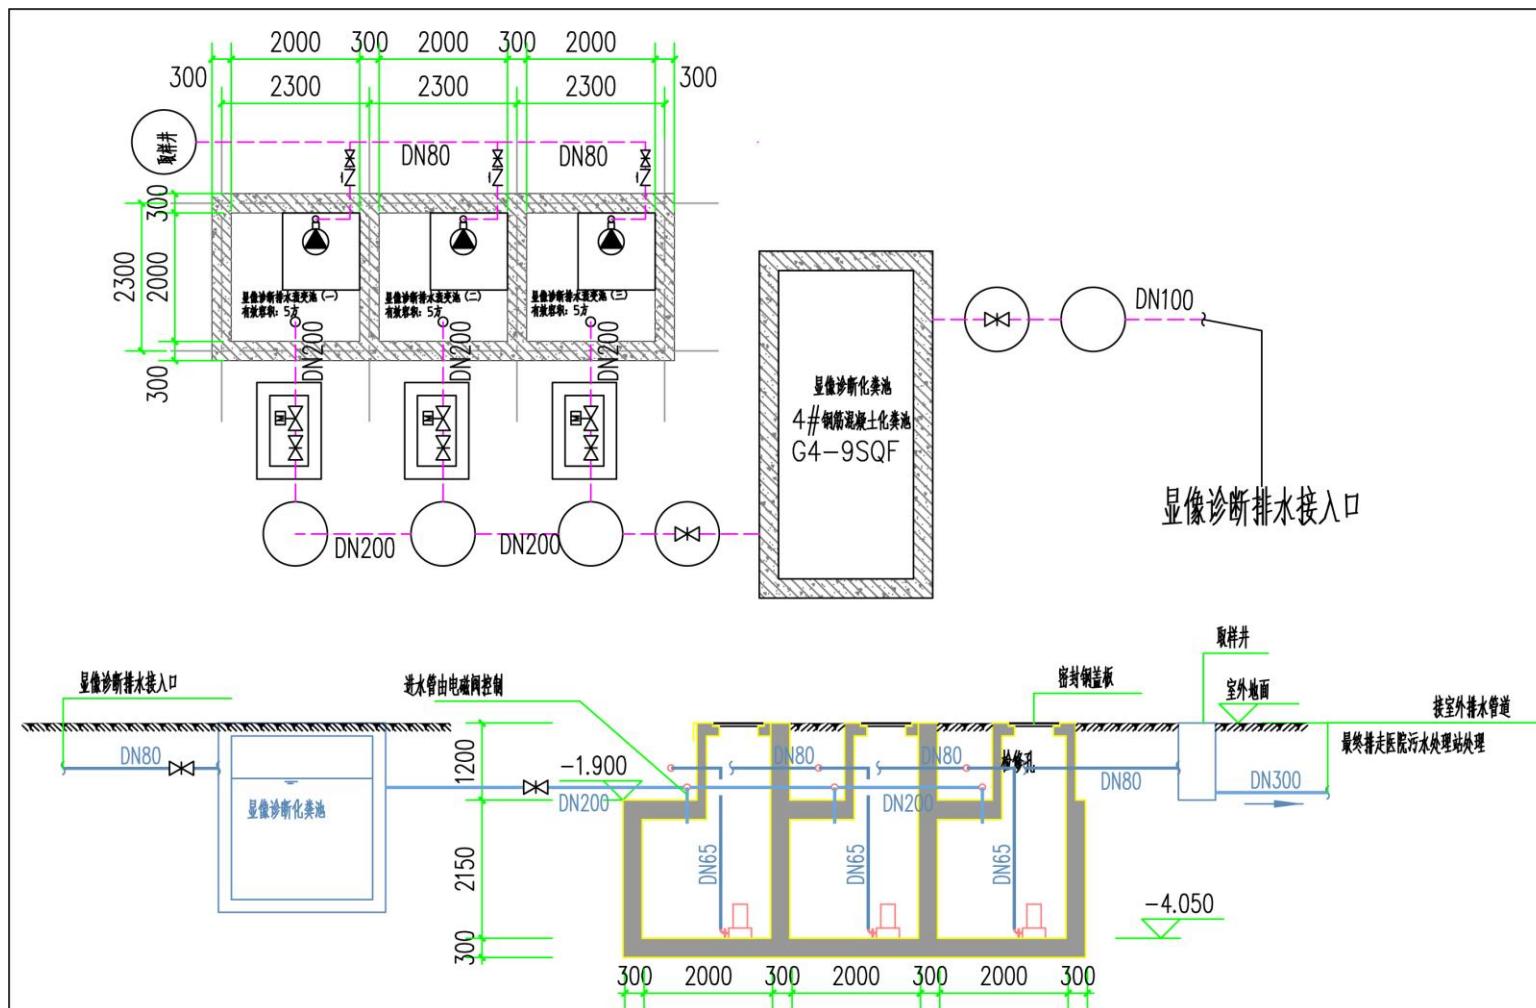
核医学科显像诊断区放射废水衰变池平面、剖面图
